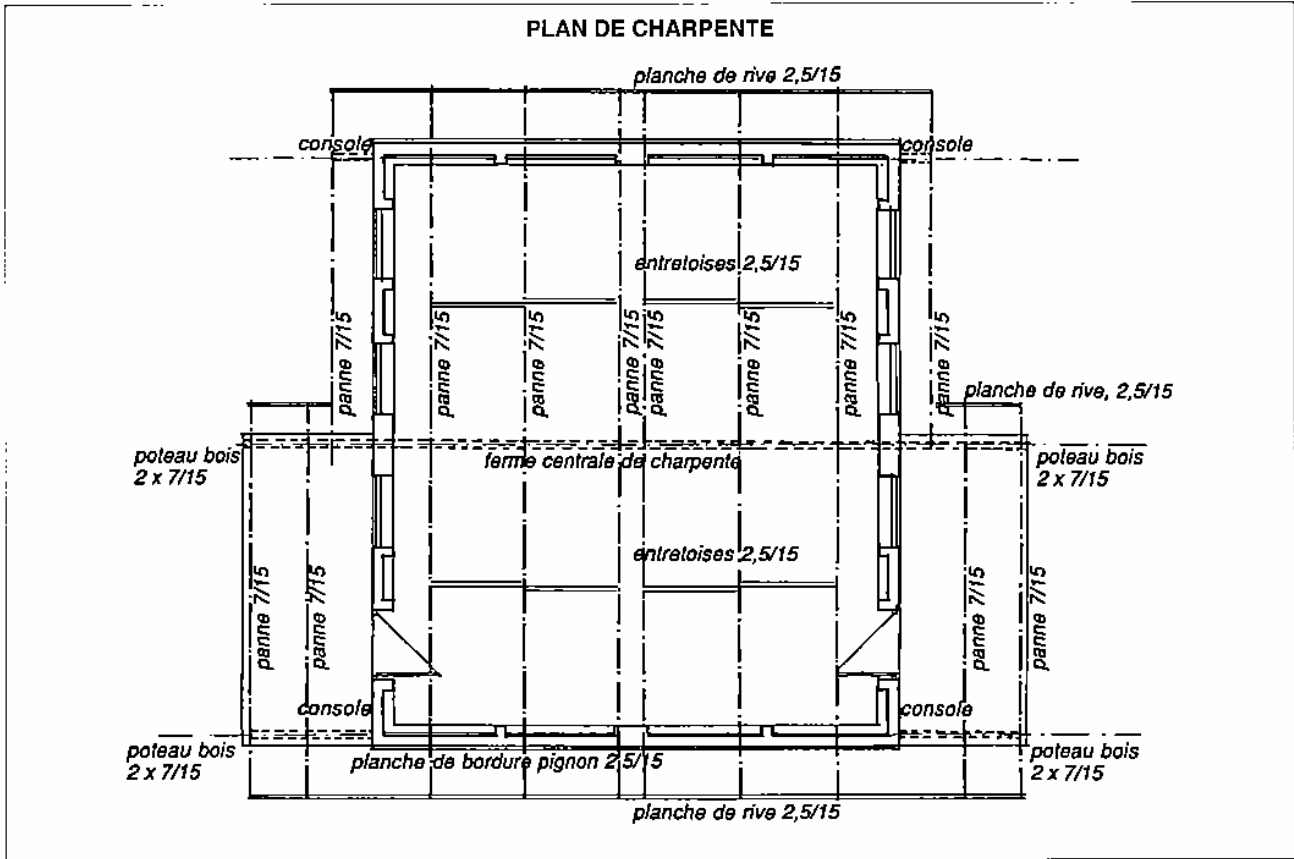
Plan de la charpente précisant le détail des sections de bois et le principe de contreventement horizontal par entretoisement des pannes.
